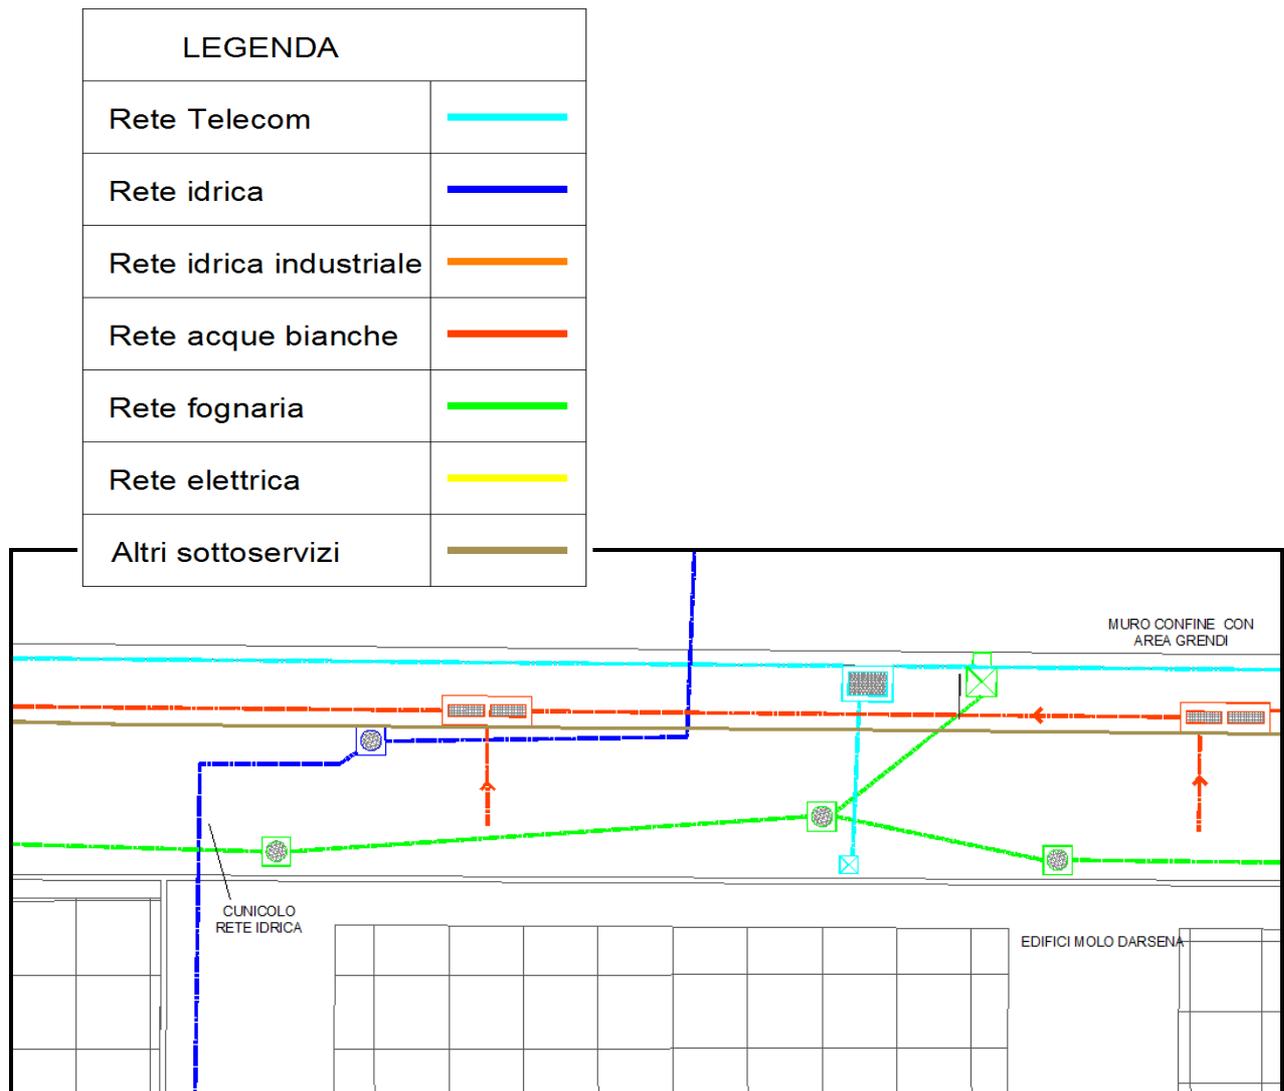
Stralcio planimetrico della disposizione dei sottoservizi individuati attraverso la campagna di indagini georadar.
